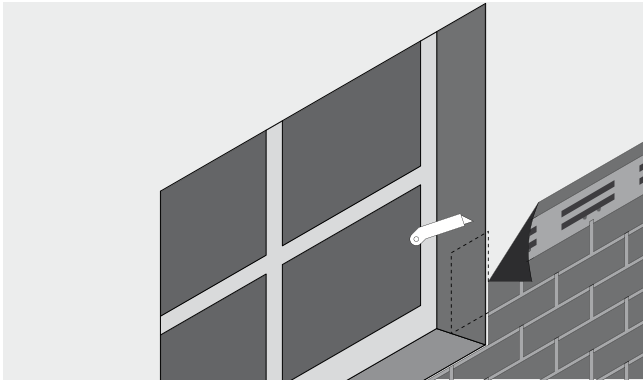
Монтаж фасадной плитки вокруг оконных проемов
